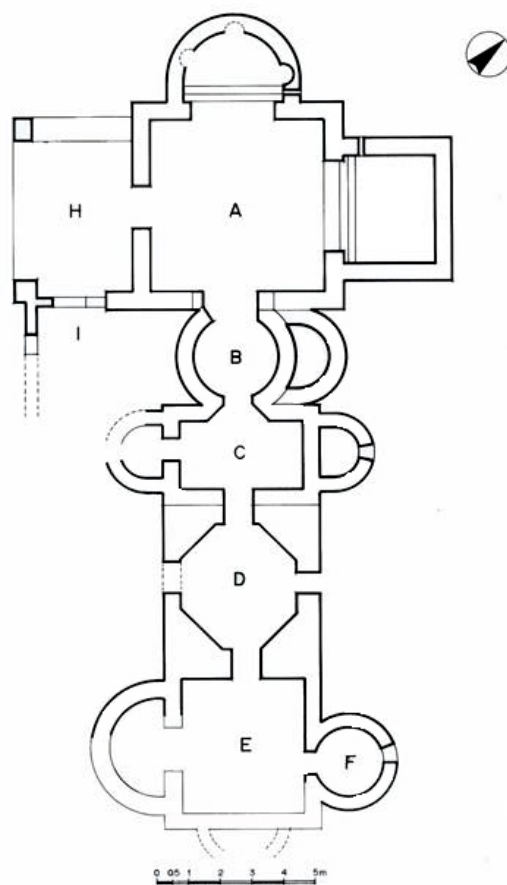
San Salvatore, Thermen von Domu 'e Cubas; Grundriss (aus: DONATI, ZUCCA 1992)
